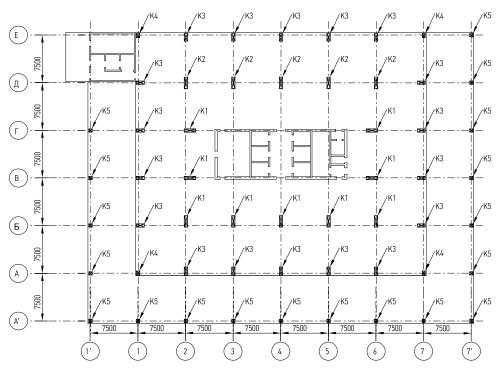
Монолитный железобетонный каркас с безбалочной системой перекрытия при сетке 7,5х7,5 м. Маркировочный план пилонов на уровнях 0 и 2
